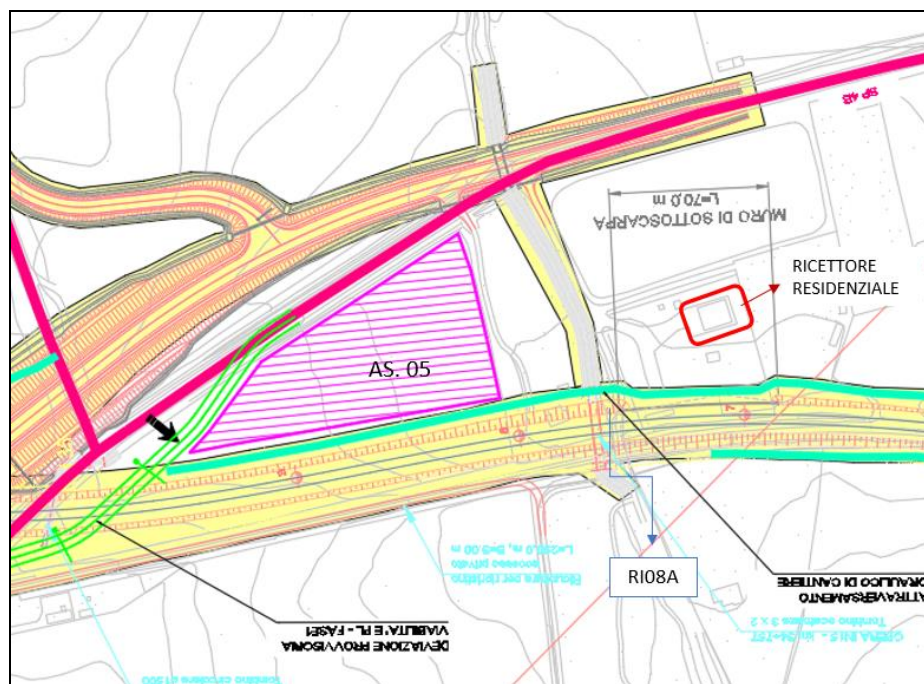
Localizzazione in planimetria delle aree di cantiere e attività di lavorazione dello Scenario di simulazione Variante di Anguillara
